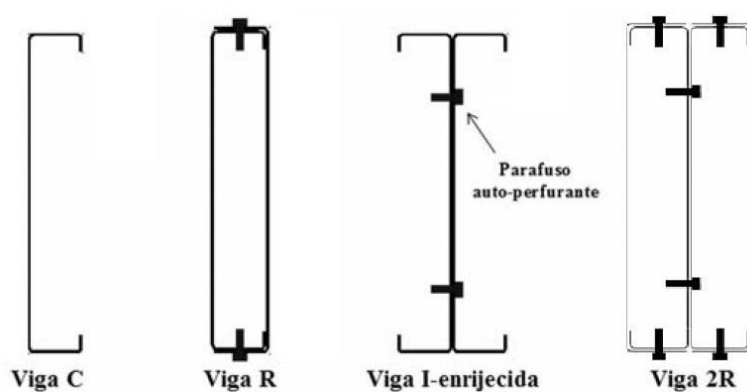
Esquema das secções transversais. (adaptado de Laim & Rodrigues, 2011b)
